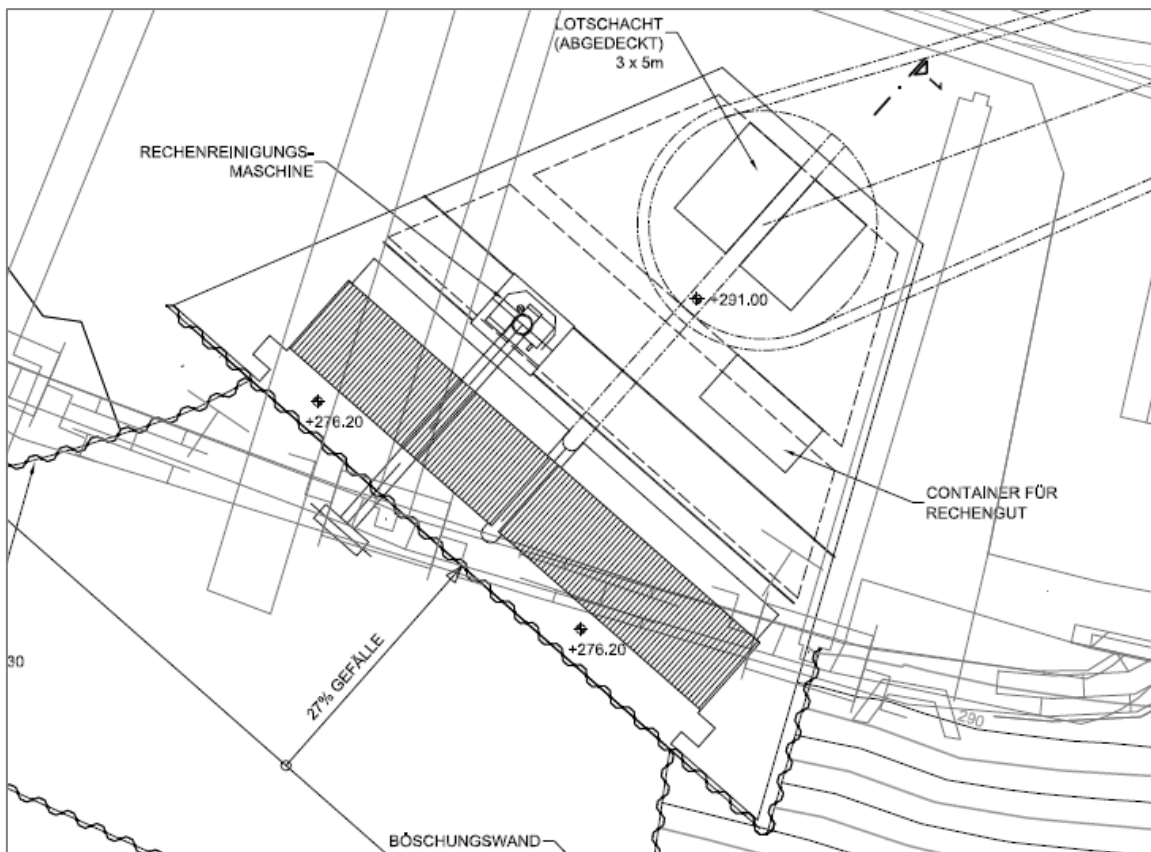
Donau, Ein-Auslaufbauwerk, Lageplan
